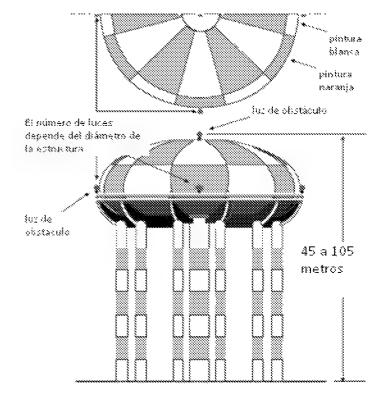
A. Configuración de luces de obstáculo para estructuras de Alturas 45 a 105 Metros
